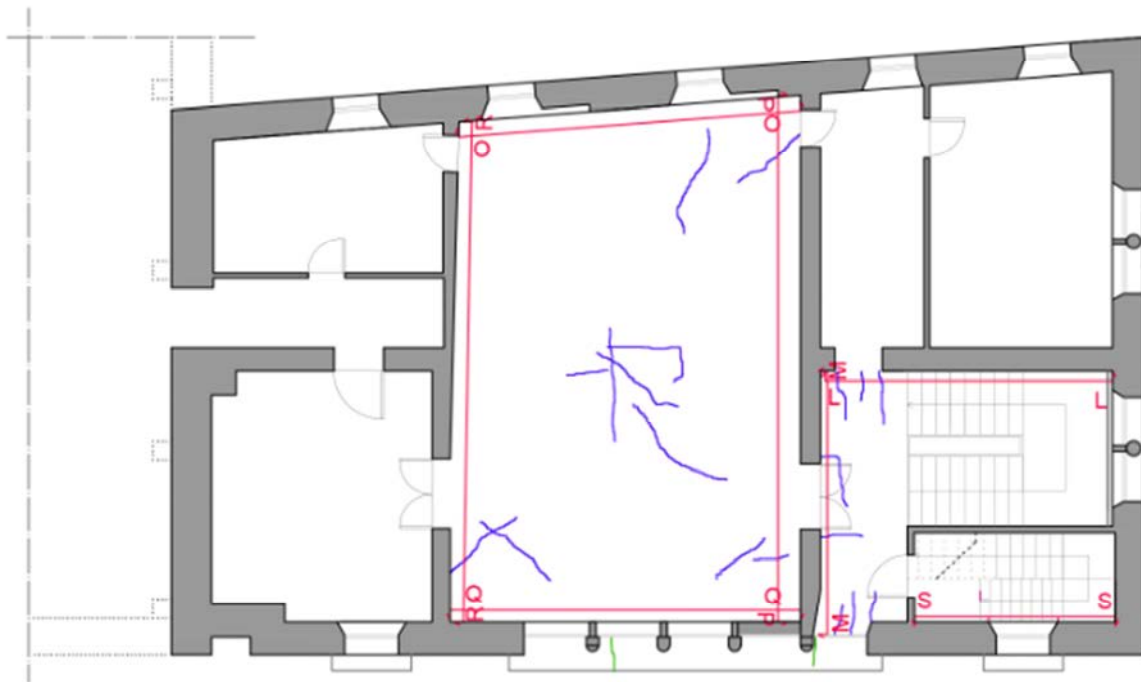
Individuazione in pianta delle fessure (in blu) che interessano il soffitto del piano secondo e di quelle (in verde) che riguardano il pavimento.
